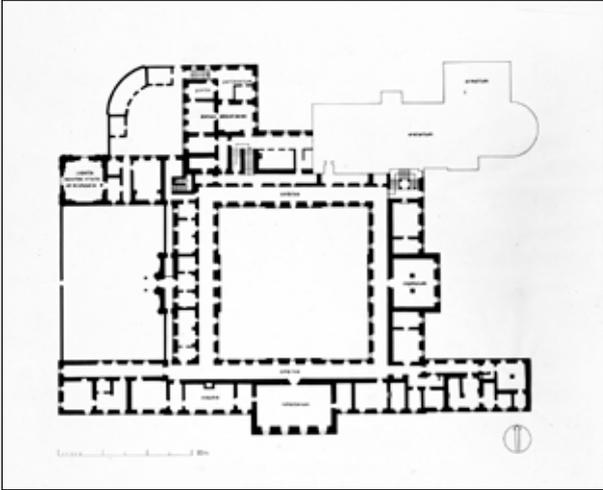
Kloster St. Marienthal, Grundriss des Konventhauses, Erdgeschoss, nach Elisabeth Hütter (1970)
